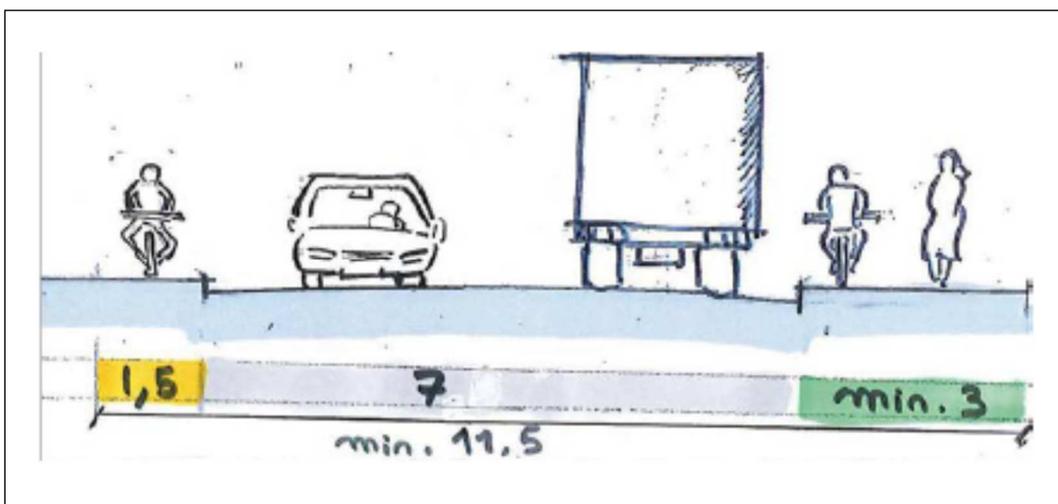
Gabarit minimum en section (en m tres) sur la RC 1 hors travers e de localit  (60 km/h < vitesse < 80 km/h)
